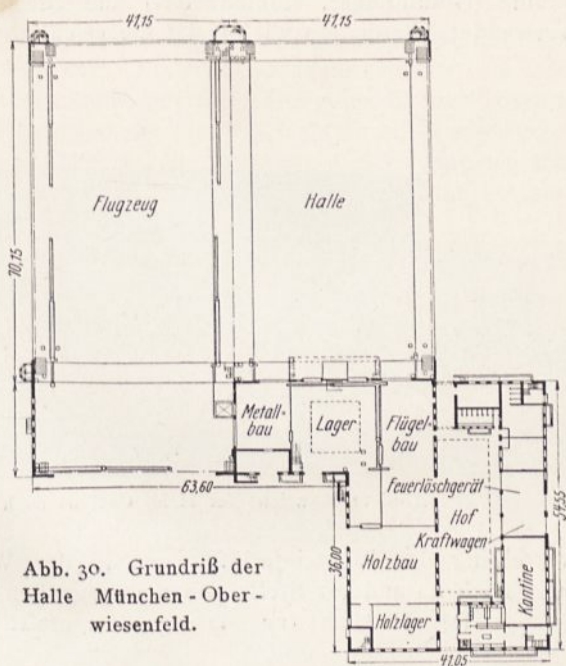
Grundriß der Halle München - Oberwiesenfeld.
